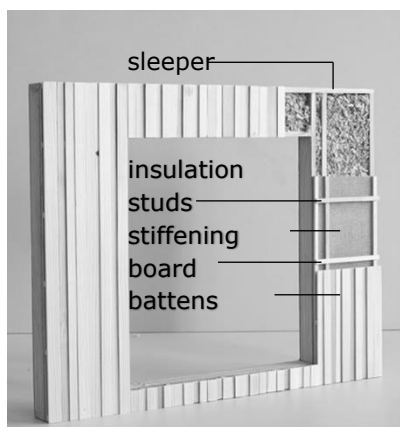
Design Konzept für Fassadenelement, Model: M. 1:20
